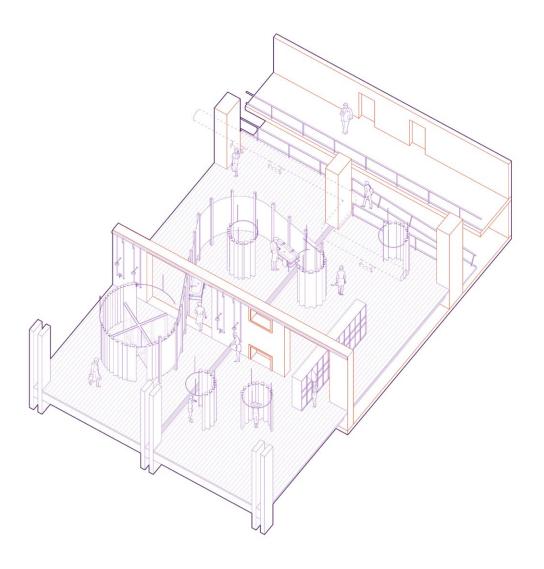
Plantas, detalle de proyecto zonas de traspaso.
